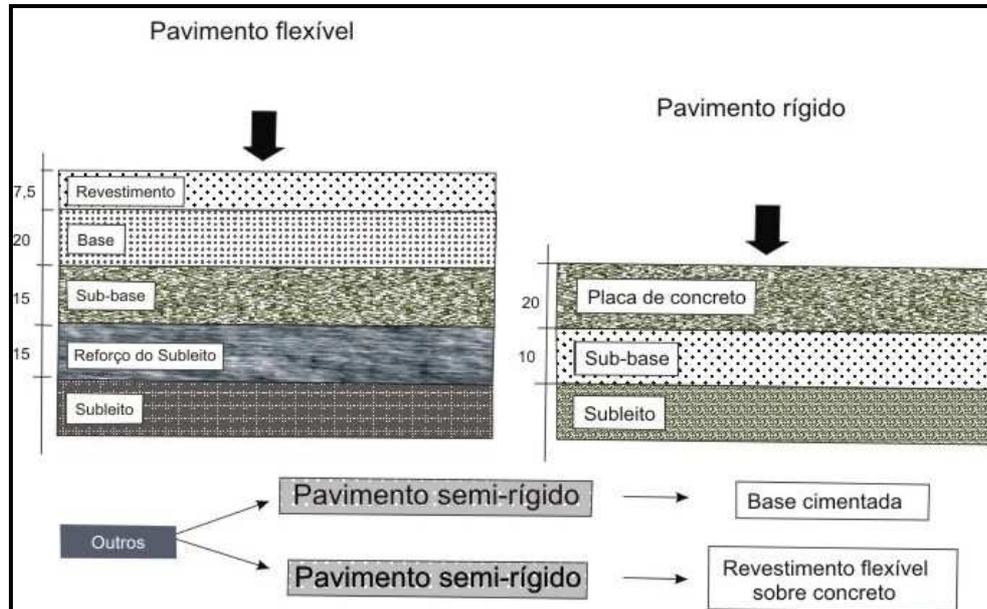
Seção Transversal Típica de um Pavimento Flexível
